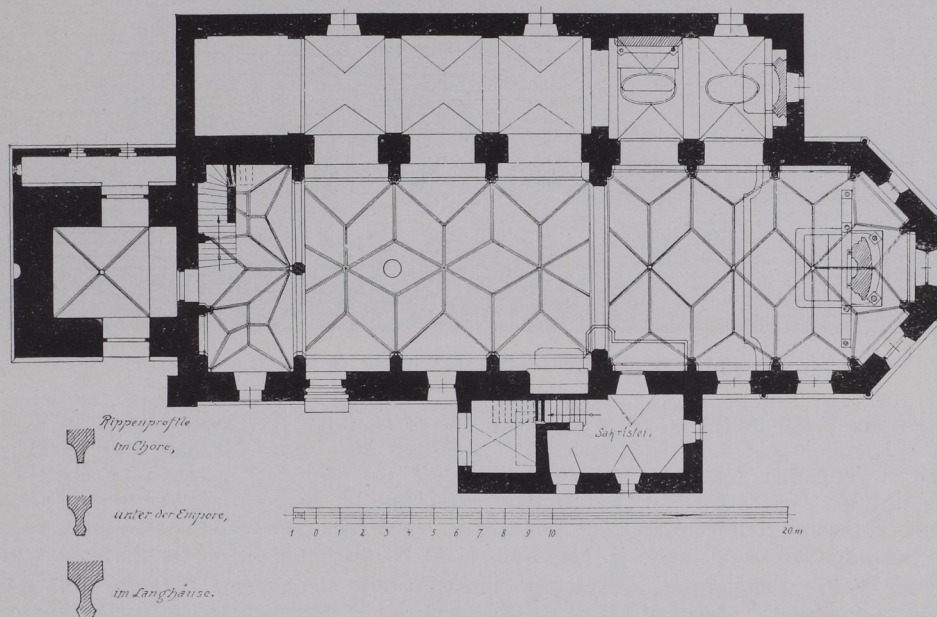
Oberalm, Pfarrkirche, Grundriß 1:300 (S. 194).
